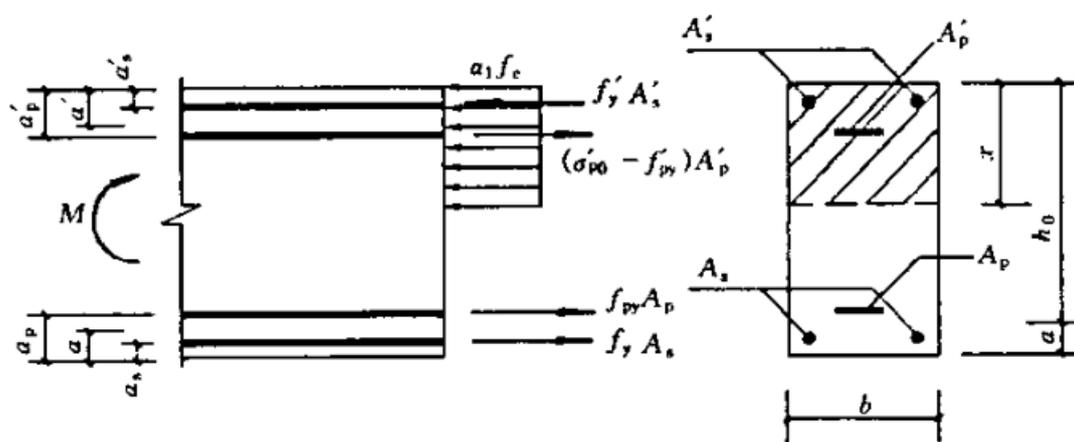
矩形截面受弯构件正截面受弯承载力计算
